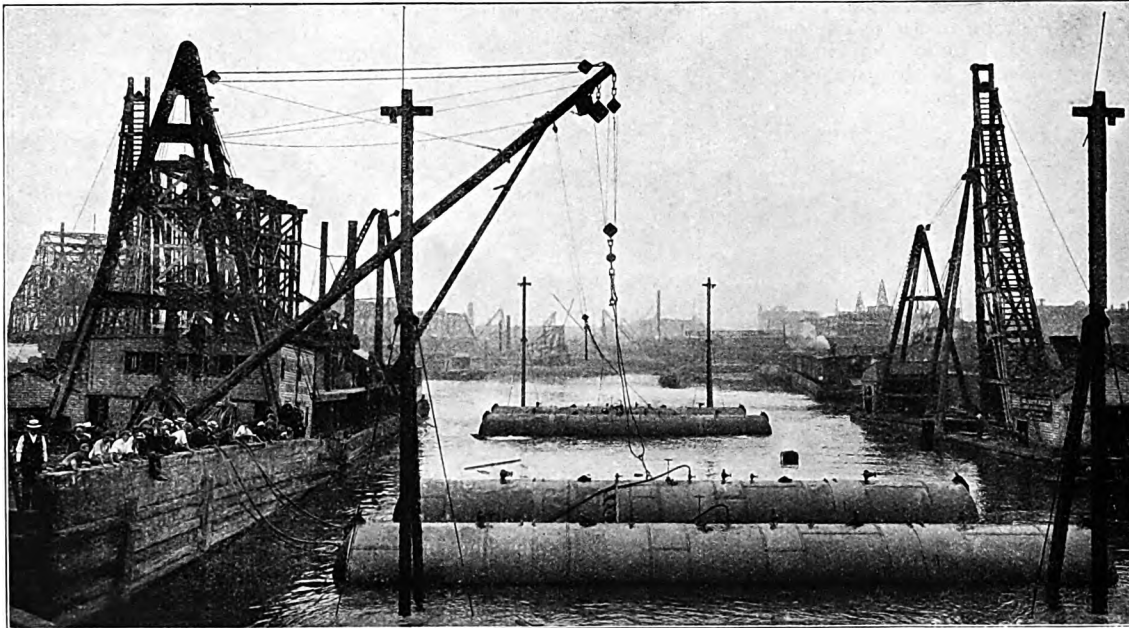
Untergrundbahn in der Lexington-Avenue in Neuyork. Bau des Harlem-Fluß-Tunnels. Ein Tunnelstück während des Schleppens zur Versenkstelle.
